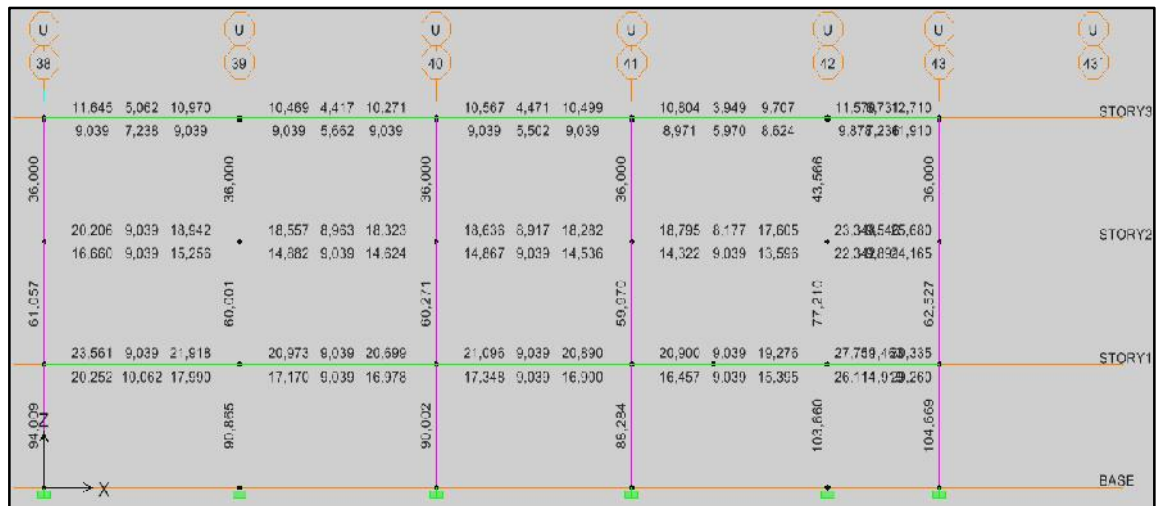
Acero en vigas pórtico U, Consulta Externa I
